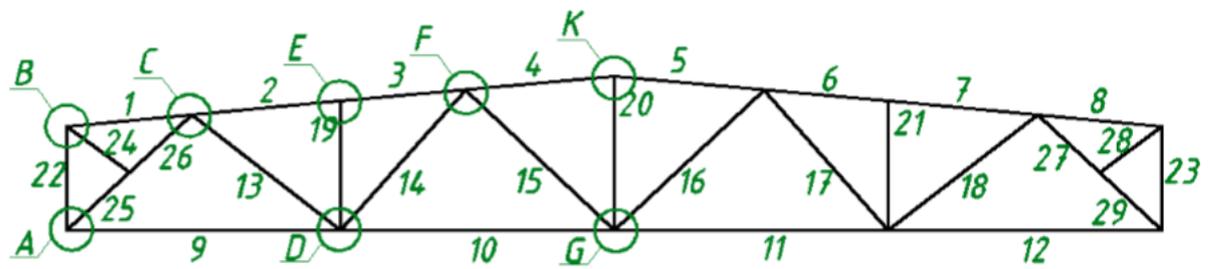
Схема фермы ФС. Номера элементов и узлы фермы.
